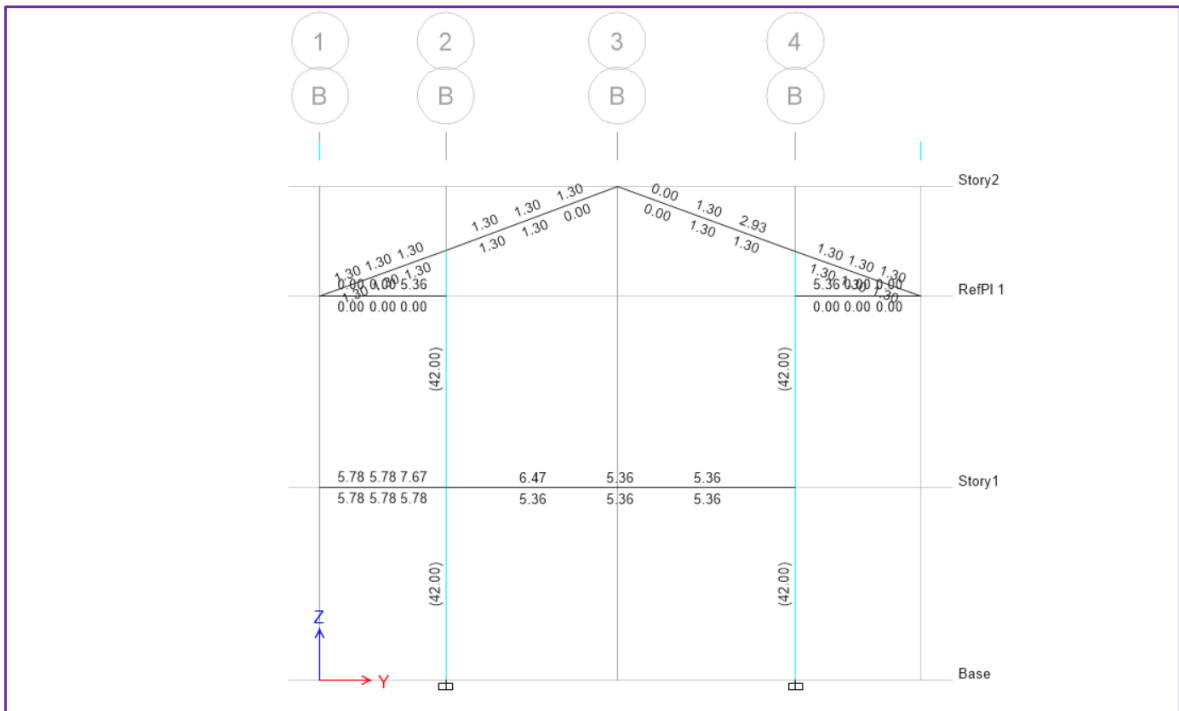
Acero de refuerzo para las vigas del pórtico.
